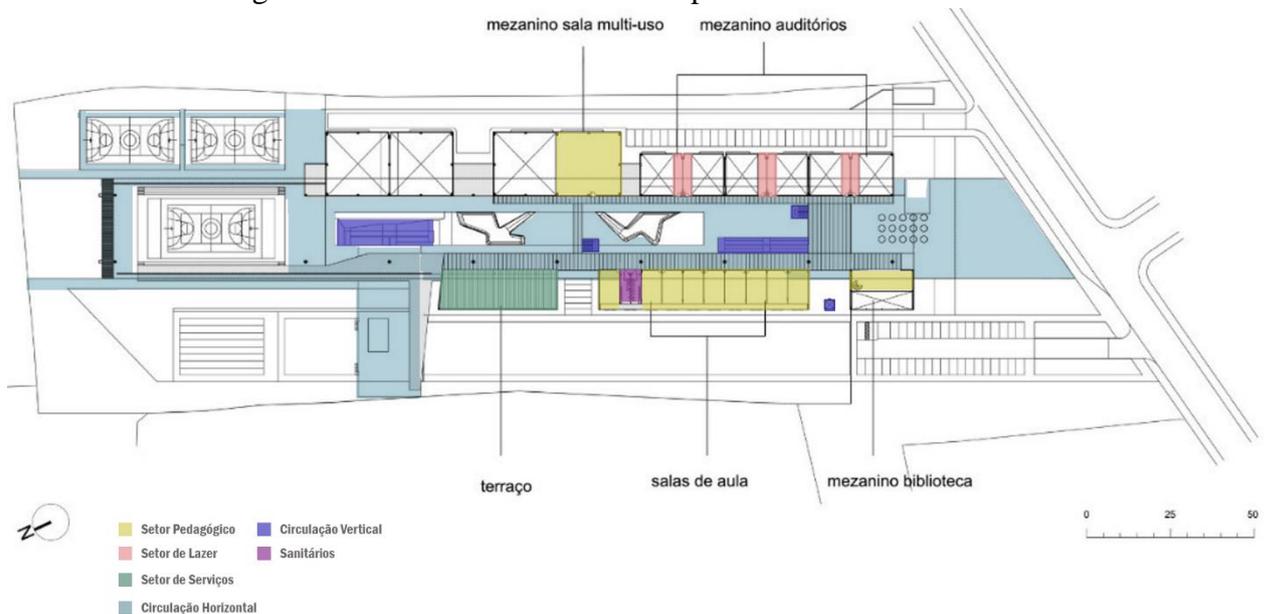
Planta do Pavimento Térreo do CEU Pimentas
